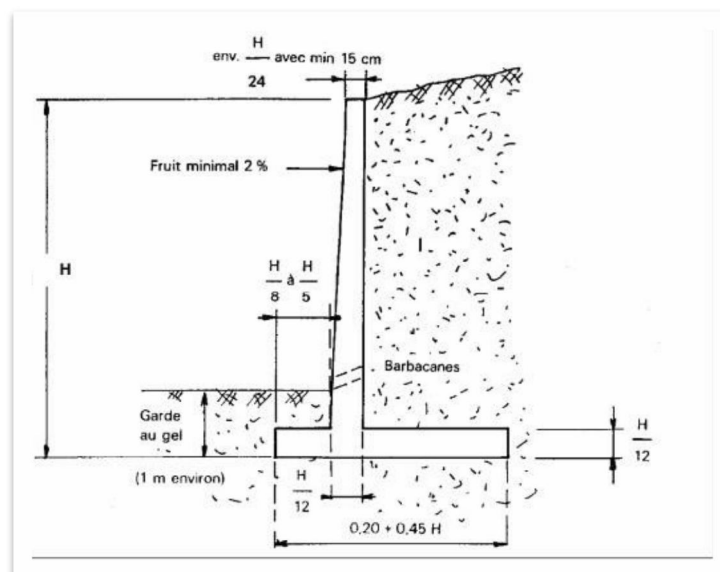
Schéma de Pré-dimensionnement d'un mur de soutènement en BA.
